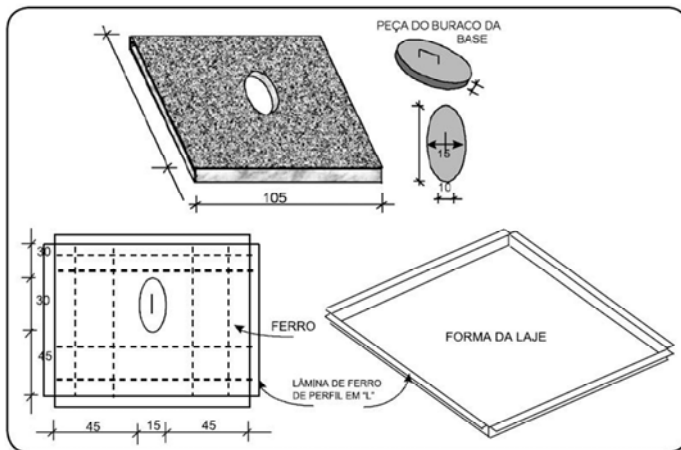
Laje de Concreto para Piso de Privada (medidas em “cm”).
